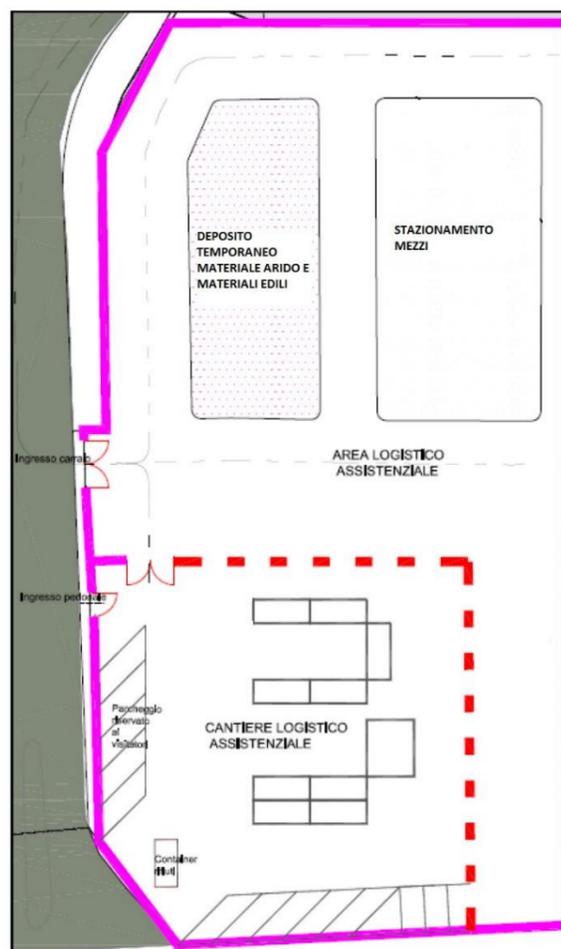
Schema tipo del cantiere logistico – Fasi 2, 3 e 4 PSA.
